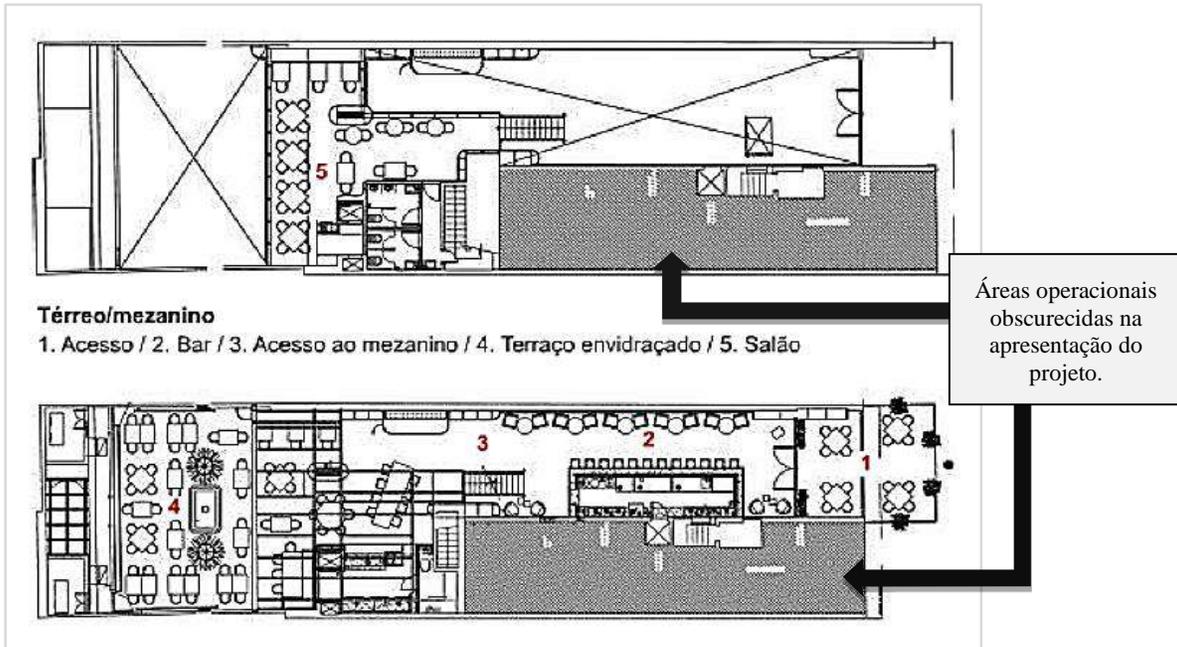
Plantas baixas publicadas em Projeto Design nº342.
